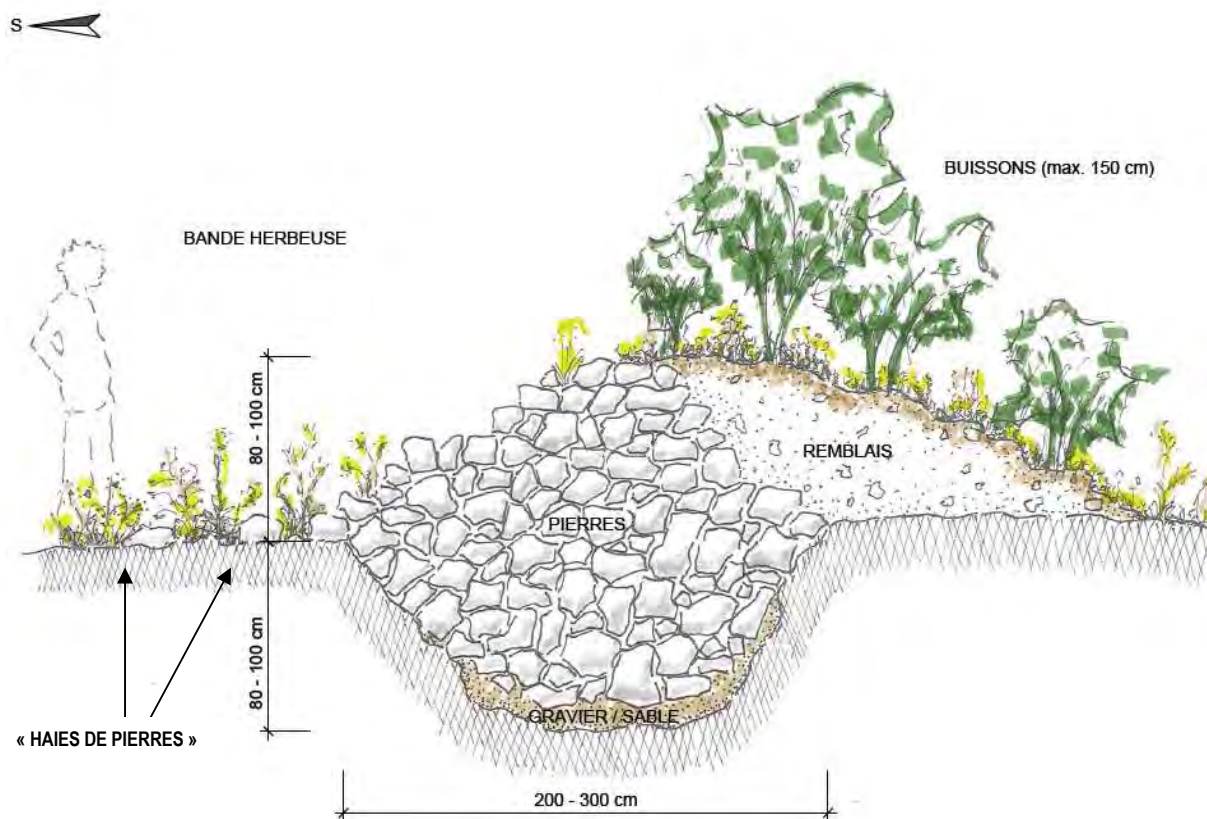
Profil d'un « tas de pierres » favorables aux reptiles
